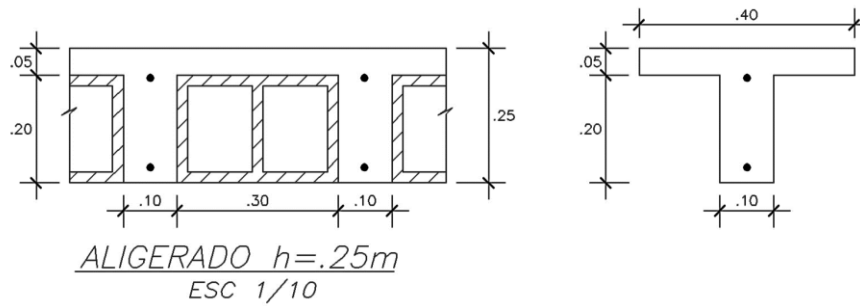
Sección típica de las viguetas de un aligerado de 25 cm.
